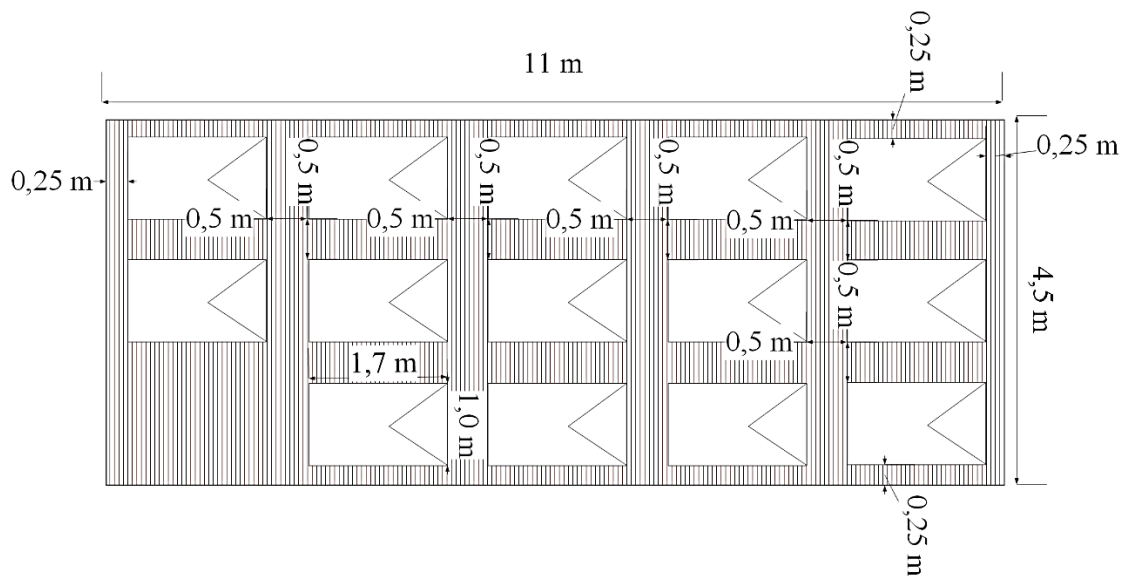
Alocação dos painéis fotovoltaicos sob o telhado.
